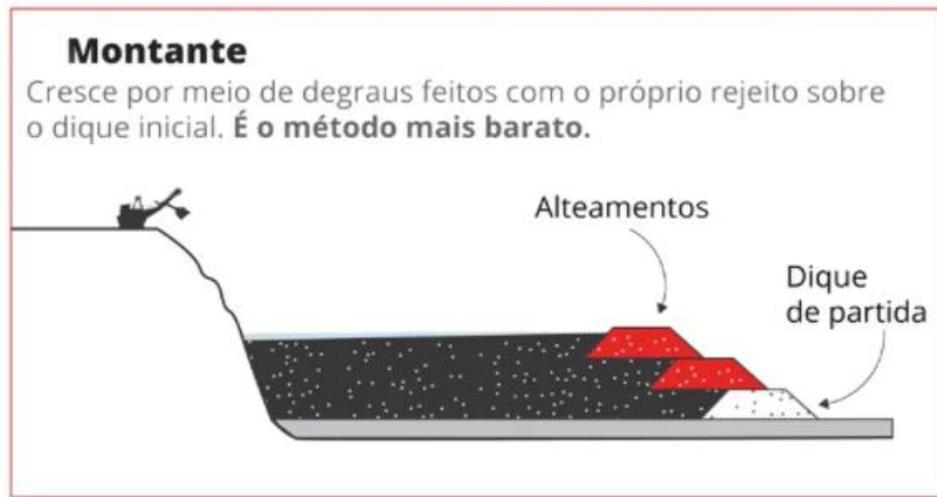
Ilustração do modelo de Barragem tipo Montante
